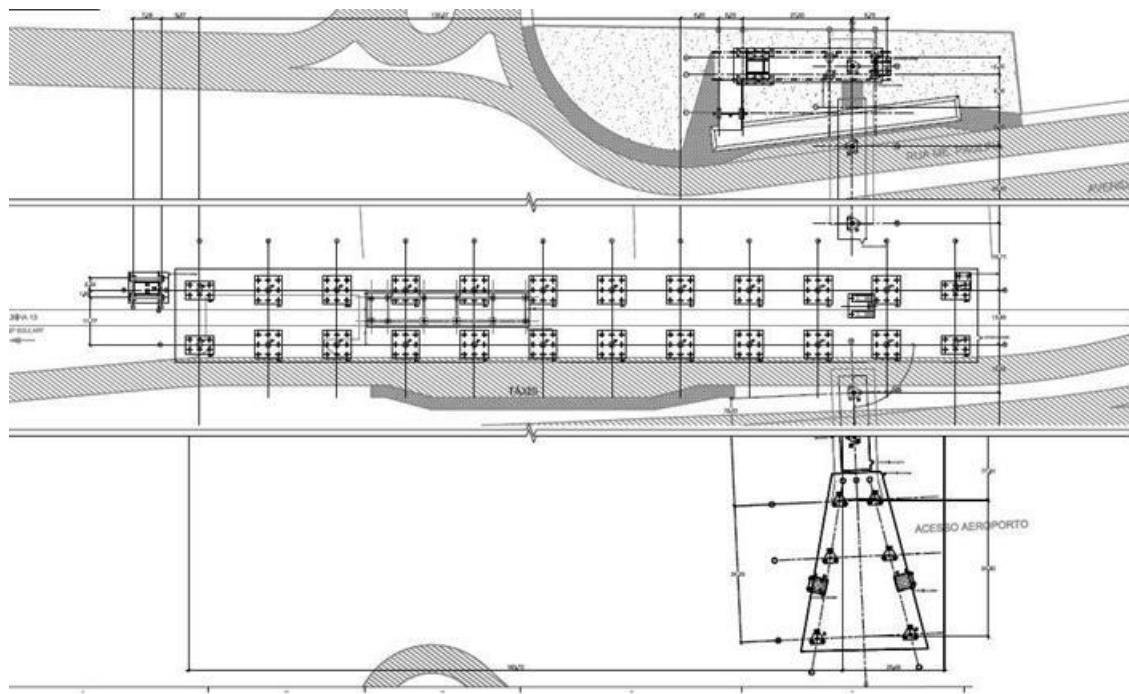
Planta de Fundações - Estação Aeroporto – Guarulhos (CPTM, 2013)
